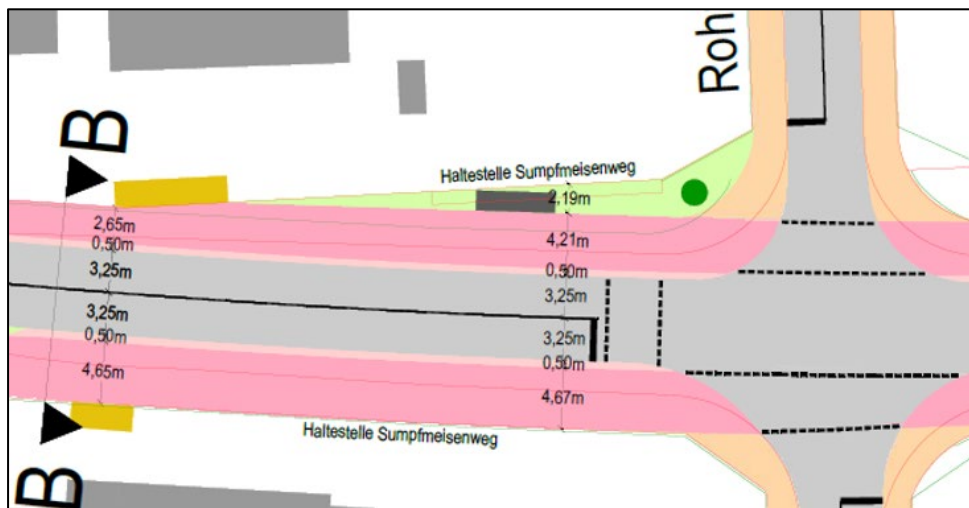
Lageplanausschnitt westlich des Sumpfmosenweges (Quelle: INOVAPLAN GmbH)
